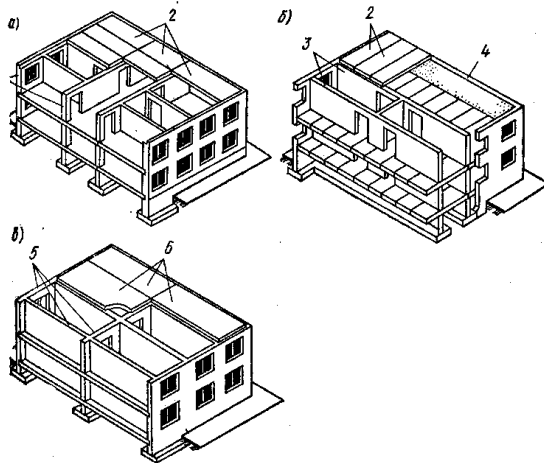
Конструктивные схемы бескаркасных зданий а – с продольным расположением несущих стен; б – с поперечным расположением несущих стен; в – перекрестная; 1 - наружные и внутренние несущие стены; 2 – плиты междуэтажных перекрытий; 3 – наружные самонесущие стены; 4 - торцовая несущая стена; 5 - продольные и поперечные несущие стены; 6 – плиты перекрытия, опертые по контуру
